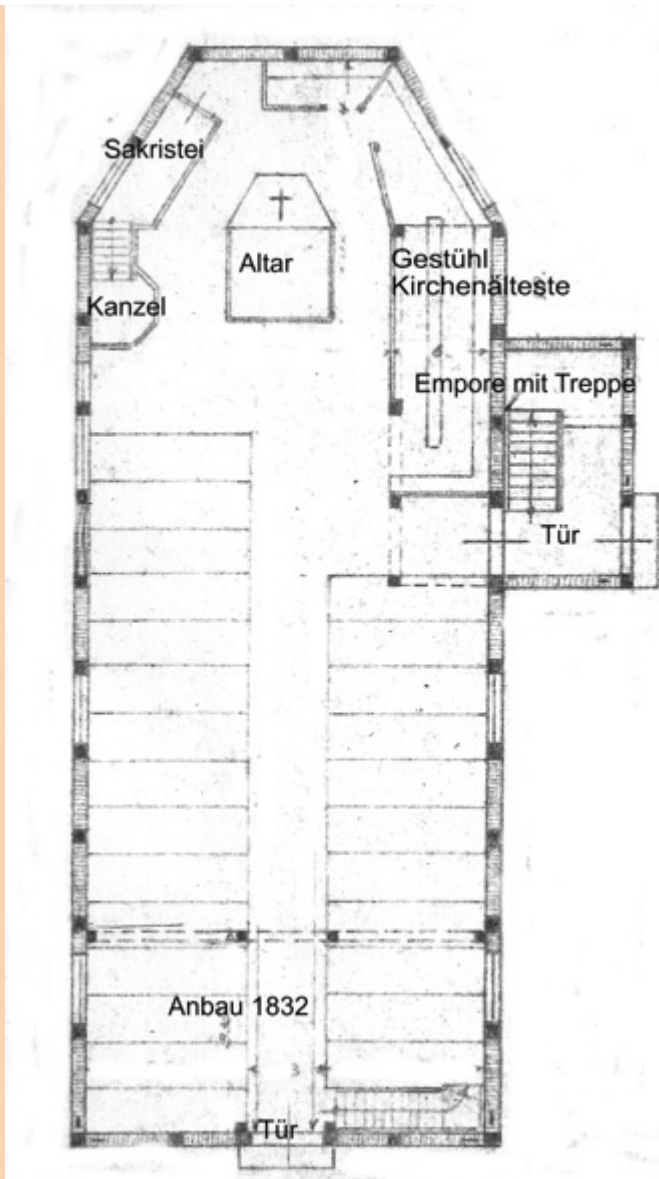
Kirchengrundriss nach dem Umbau 1831
